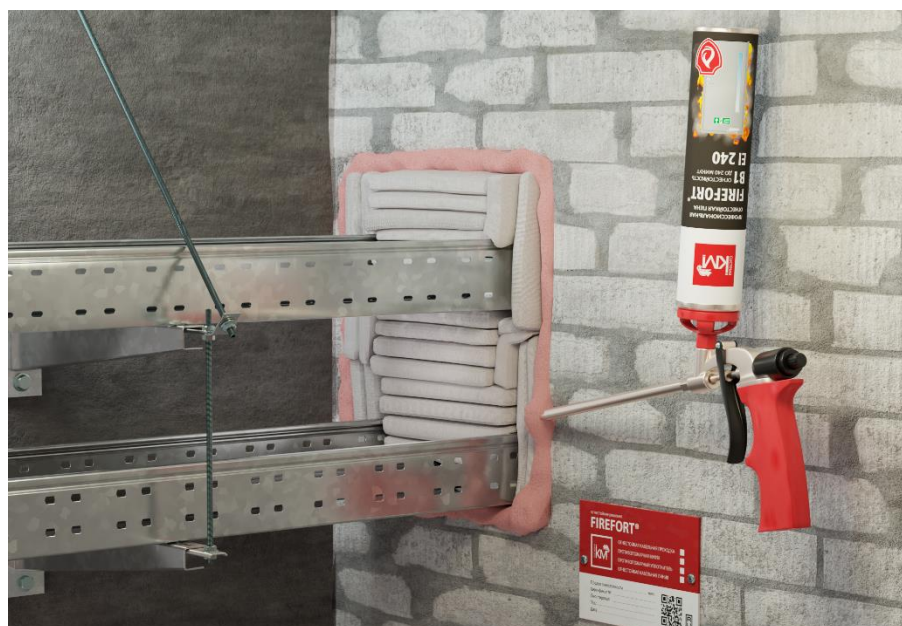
Монтаж проходки кабельной на основе огнезащитных подушек KM-FF-P
